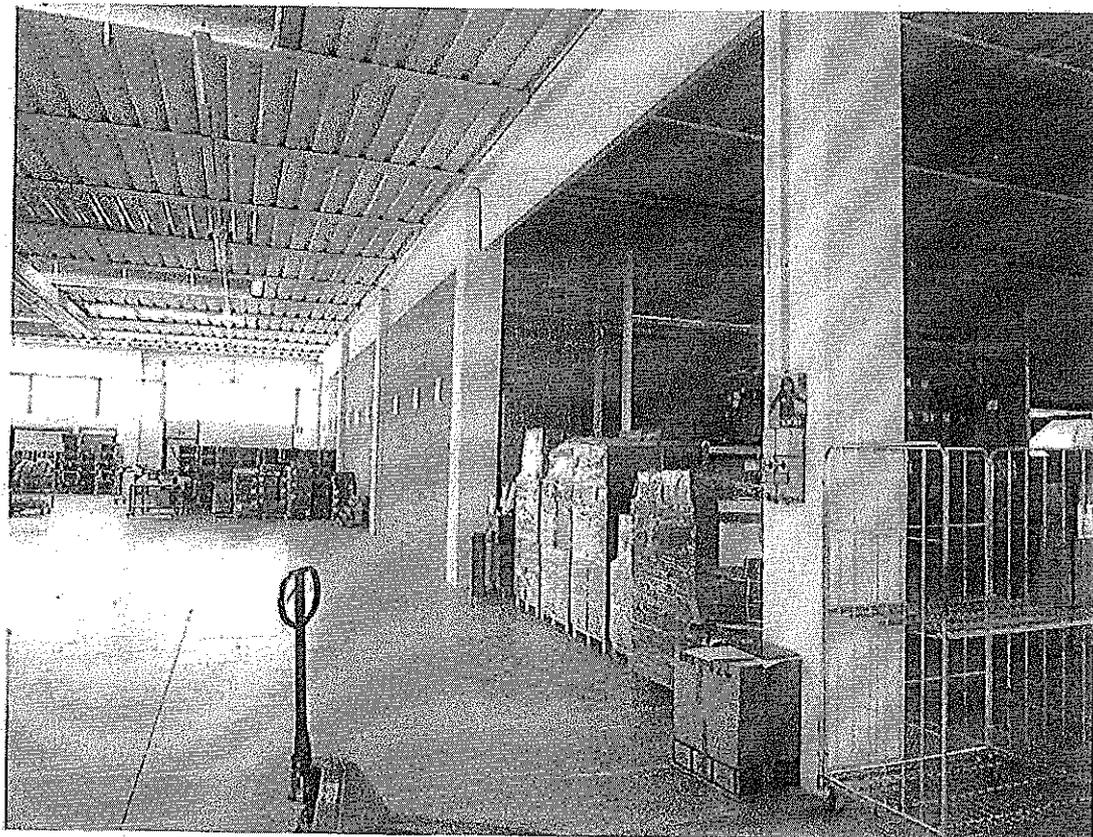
Corpo fabbrica produttivo – vista laterale.
